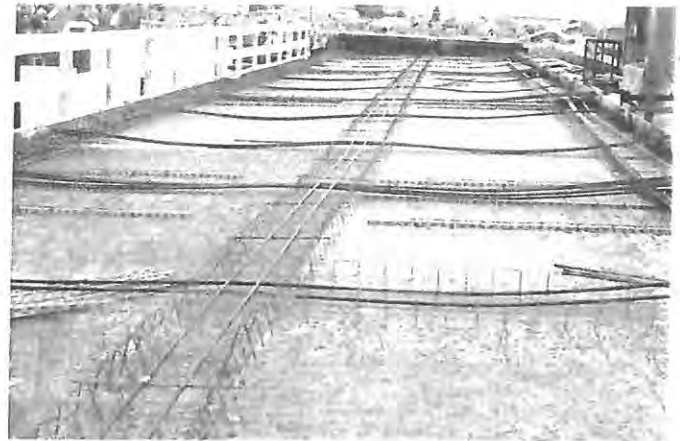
vorgespannte Decke mit Stahlfaser-Bewehrung
